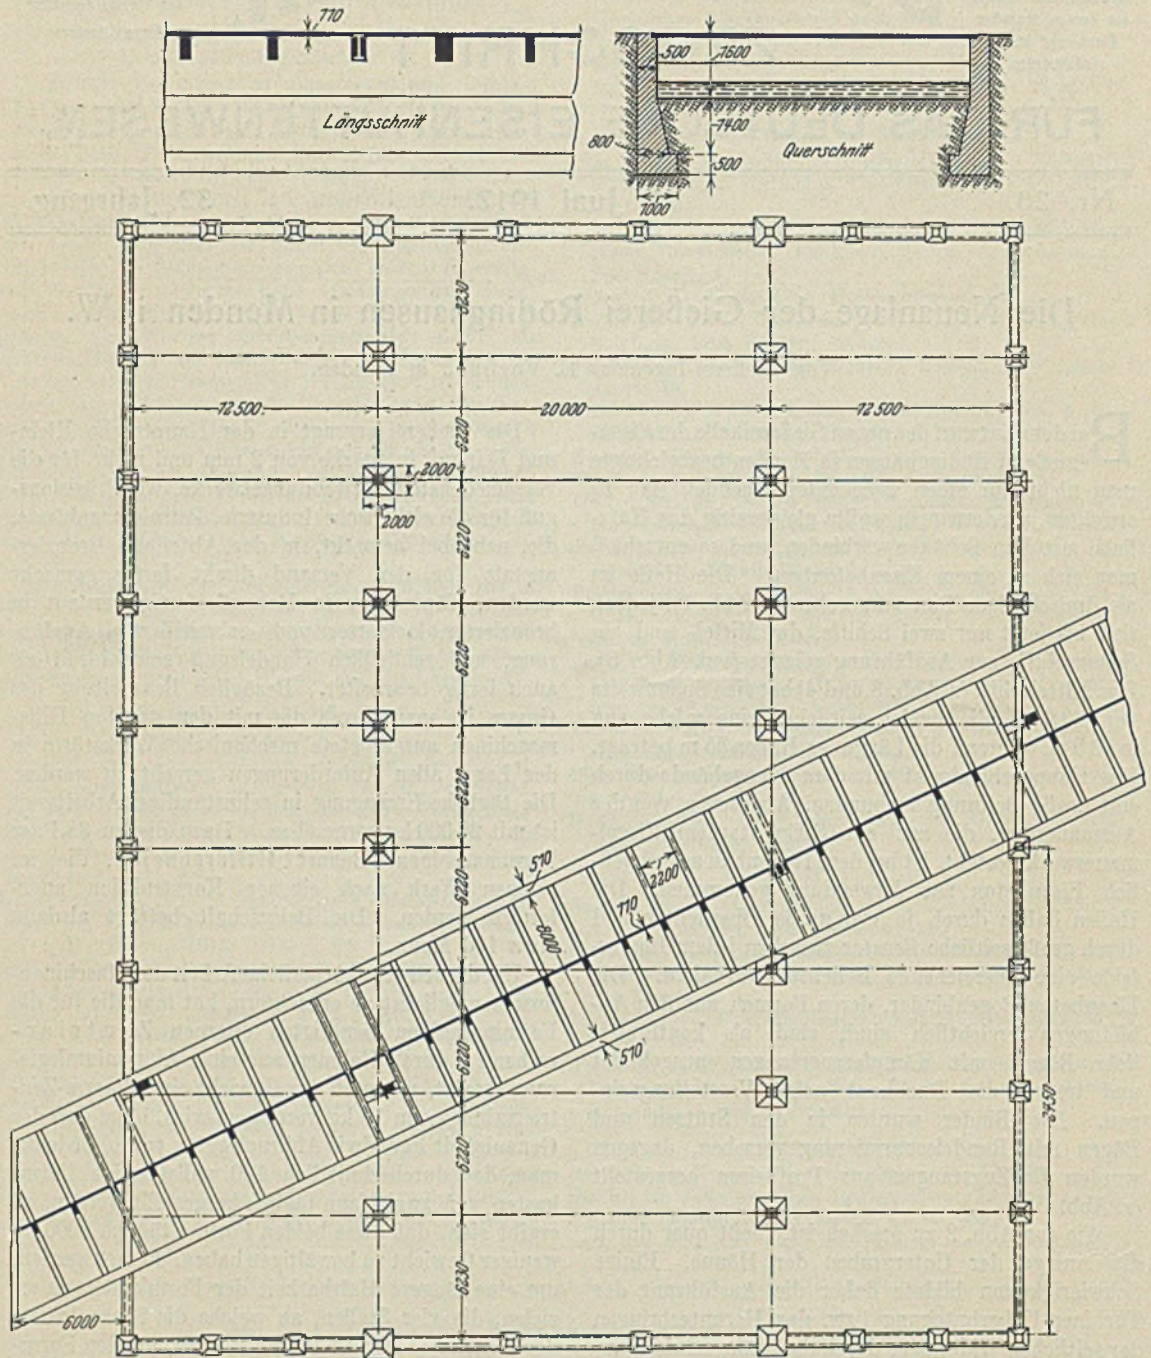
Eisenbetonbauten zum Neubau der Eisengießerei Rödighausen, Grundriß.
